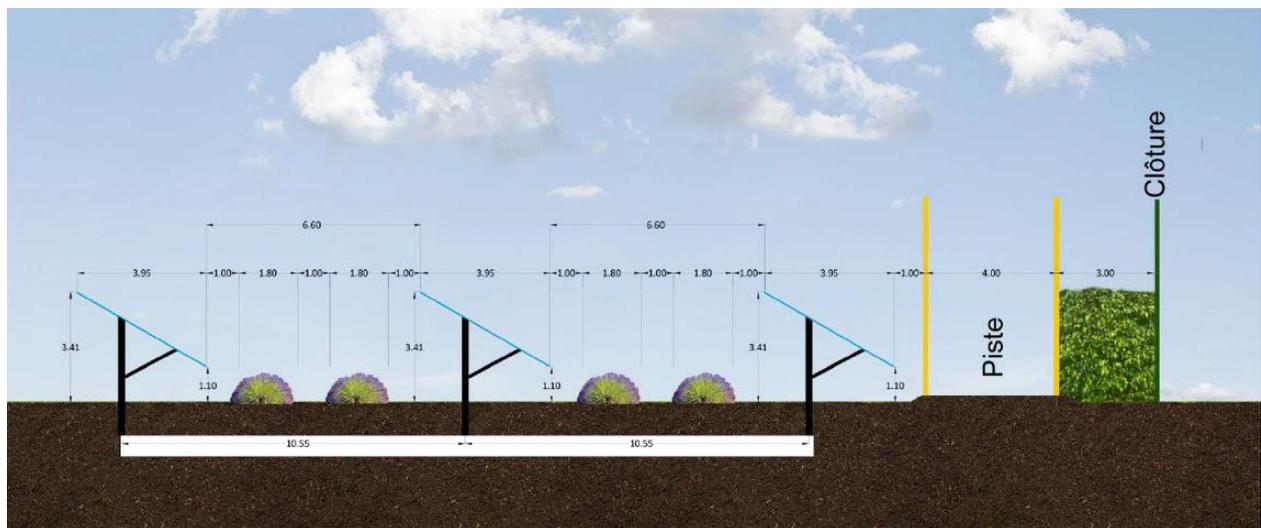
Plan en coupe de la zone 1 pour les PPAM (Valeco)
